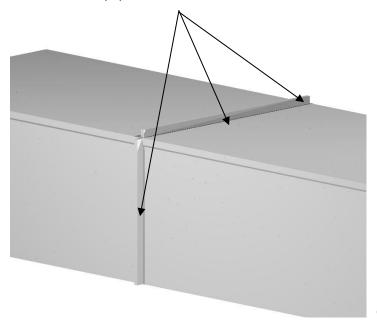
Conduit avec raccord à joint debout <sup>2</sup>
